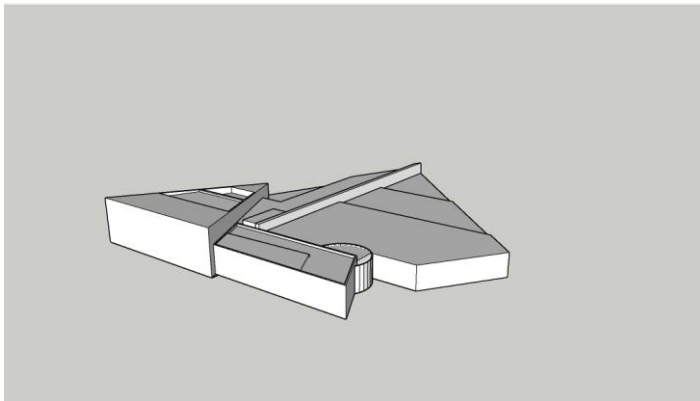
Imagen de elementos en la cubierta de la Biblioteca [13]
